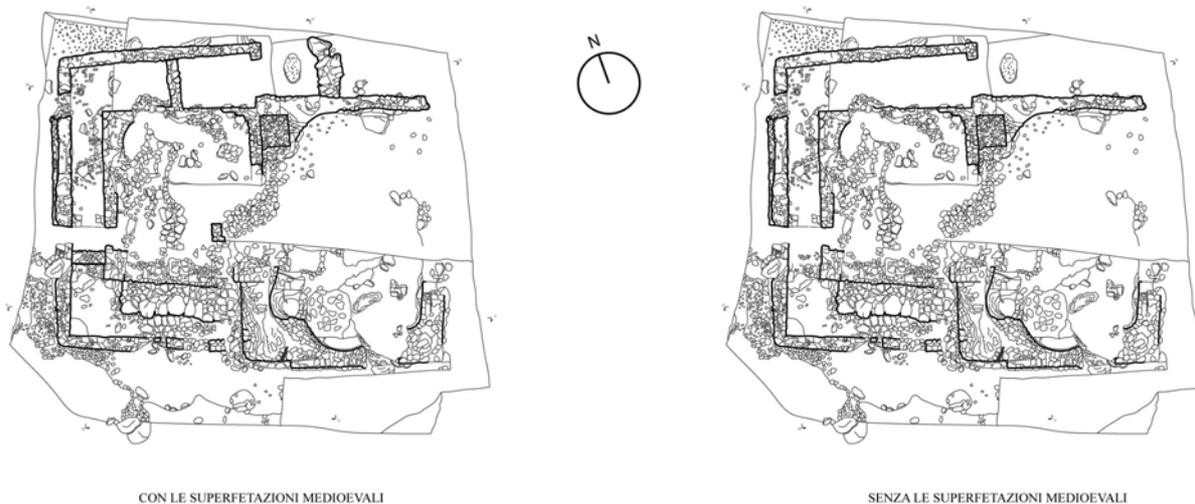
Planimetria dell'edificio nell'area 1 con e senza le strutture medievali
